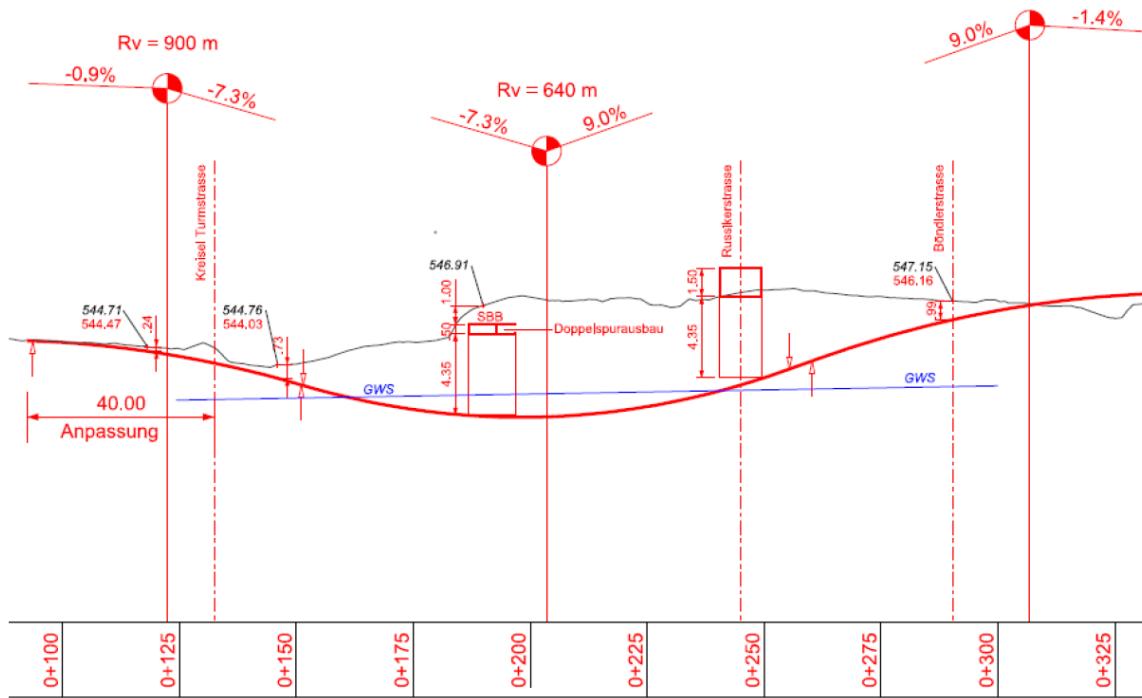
Längsschnitt Unterführung Tunnelstrasse, Variante 1 gemäss Bericht SNZ 2023
